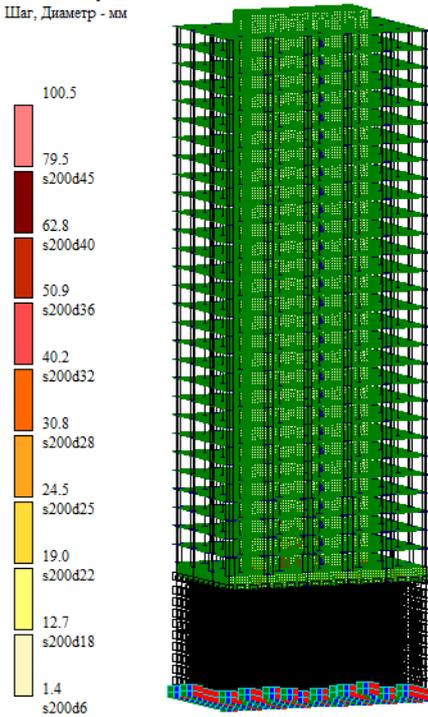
Схема армирования наружной части стен по оси OX, OY
